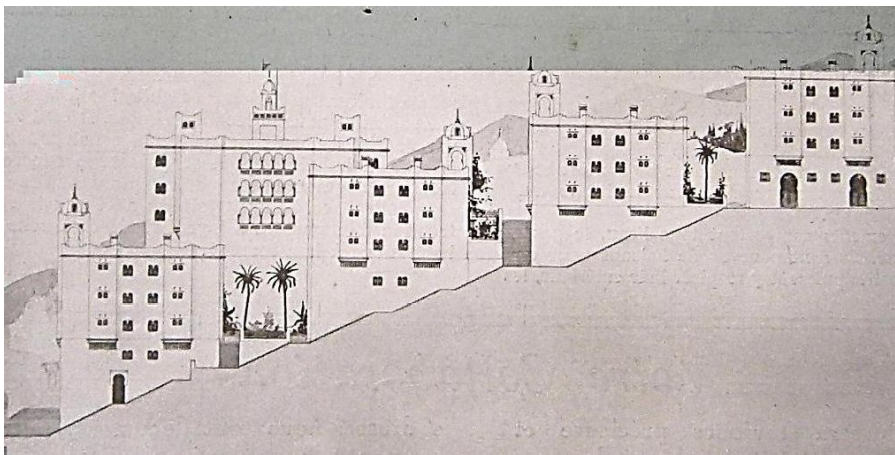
Maquette du groupe indigène du boulevard Verdun actuellement boulevard Abderrazak Hadad.
